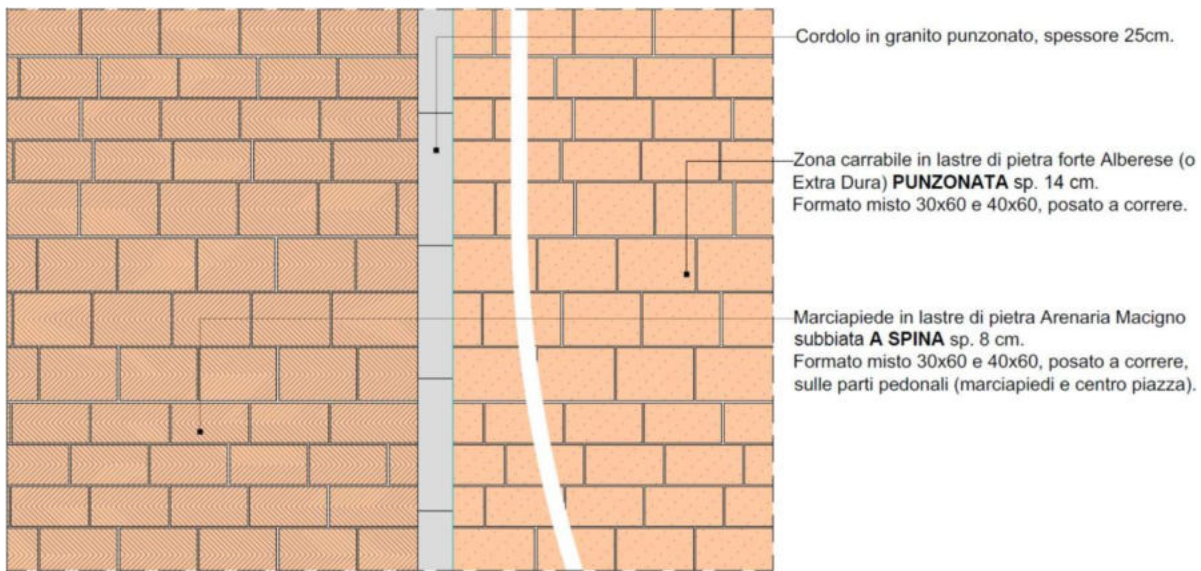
Progetto Esecutivo – Pianta piazza San Marco con tessitura della pavimentazione
